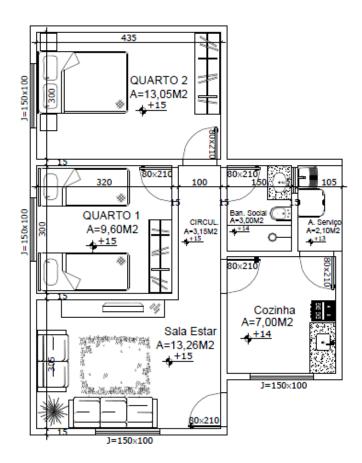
Planta baixa. Fonte: Elaborada pelo autor (2014).
